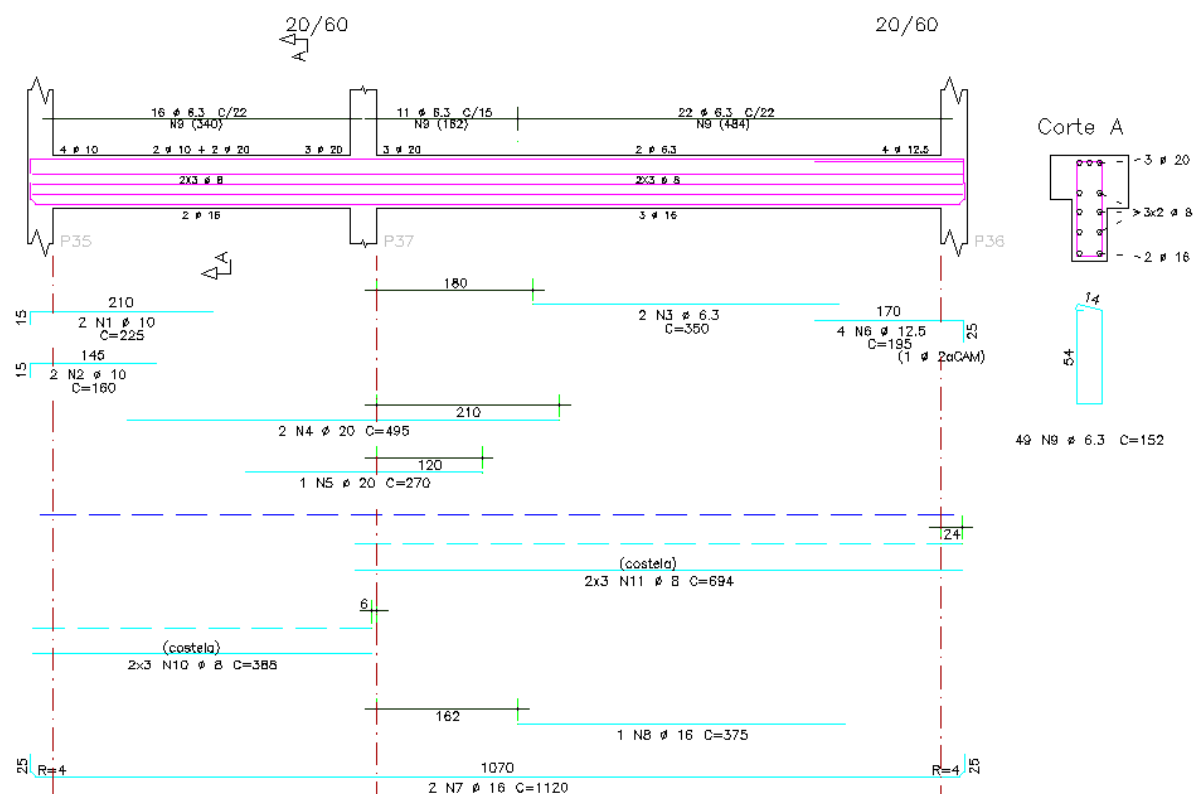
Armaduras da viga V12 do pavimento Biblioteca da Solução Convencional
